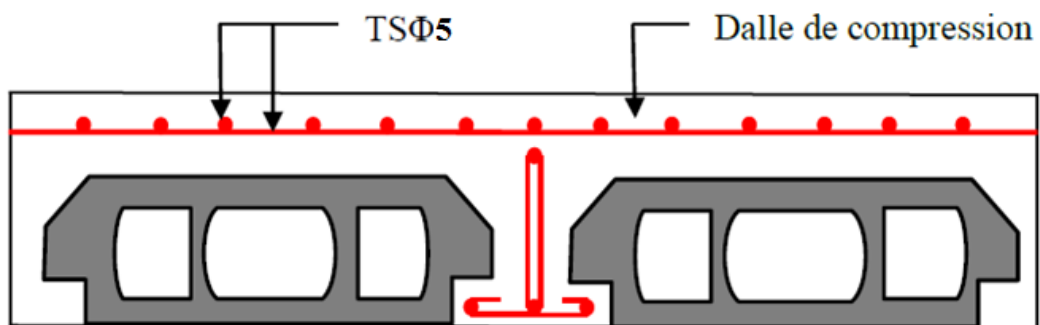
Schéma de ferrailage de la dalle de compression.
